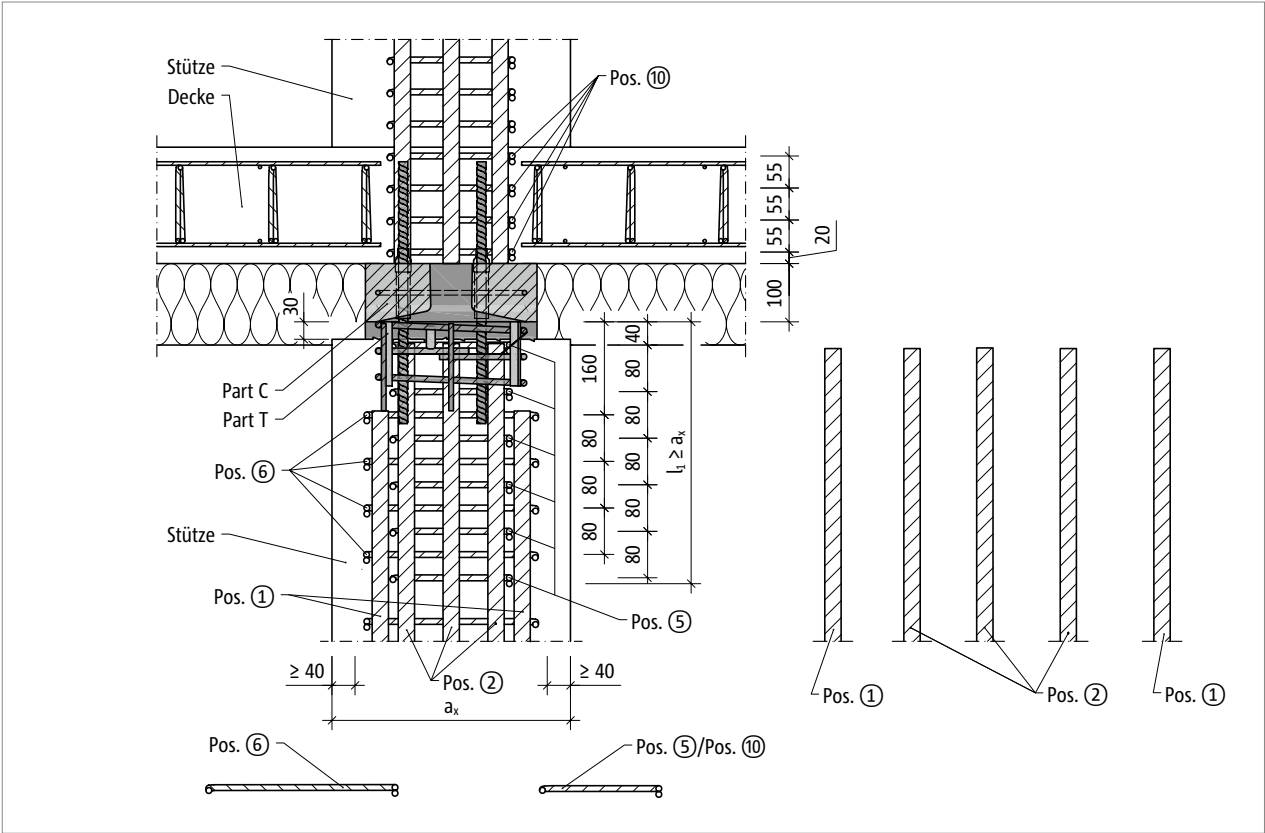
Schöck Sconnex® Typ P-O: Bauseitige Bewehrung im Stützenlängsschnitt A-A (gilt auch für Typ P-U)
